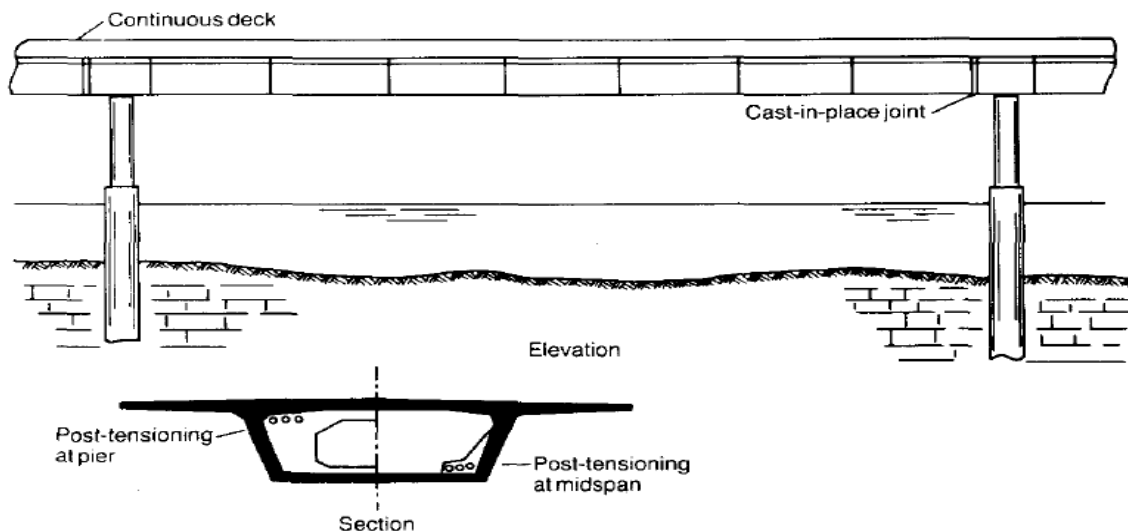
Esquema típico superestructura vano a vano. Adaptado de: Moreton A.J. (1990). Segmental bridge construction in Florida: a review and perspective.
